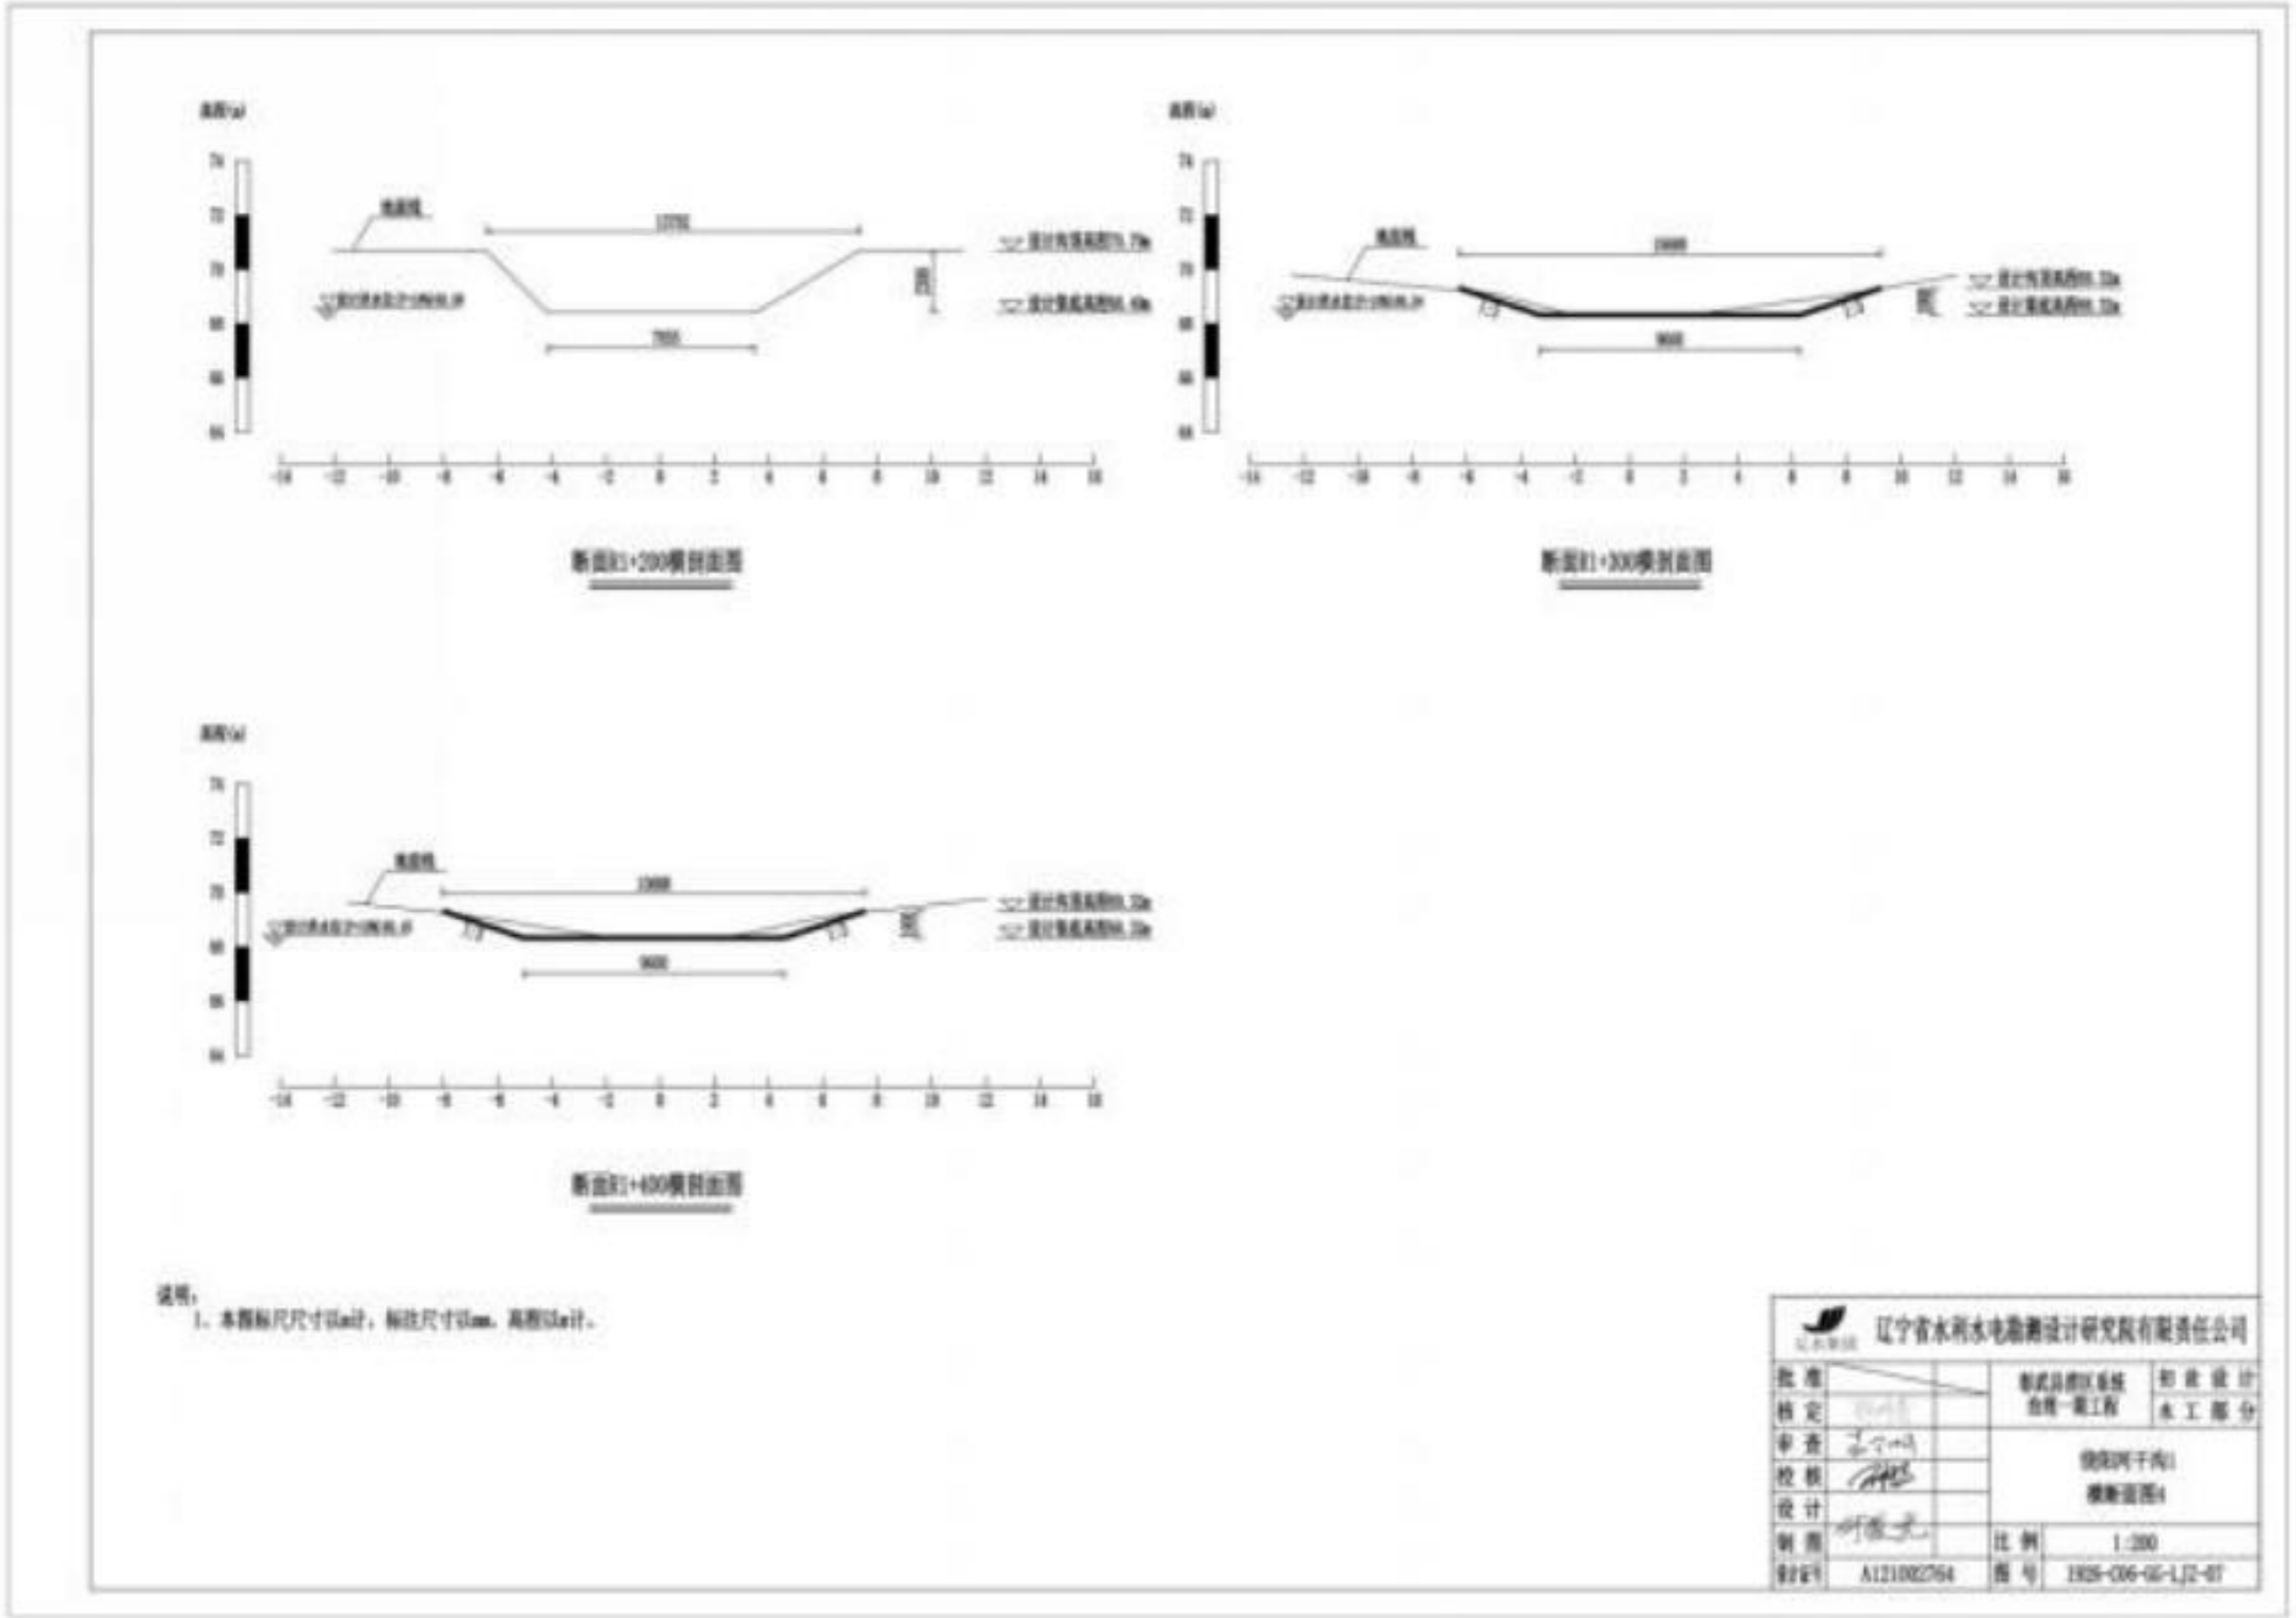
(4) 两家子镇绕阳河干沟 1 剖面图
